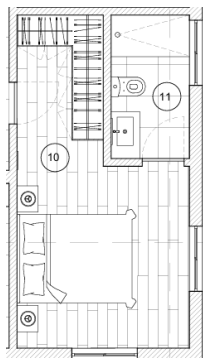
Quarto 1 e instalação sanitária privativa, excerto da planta de apresentação
